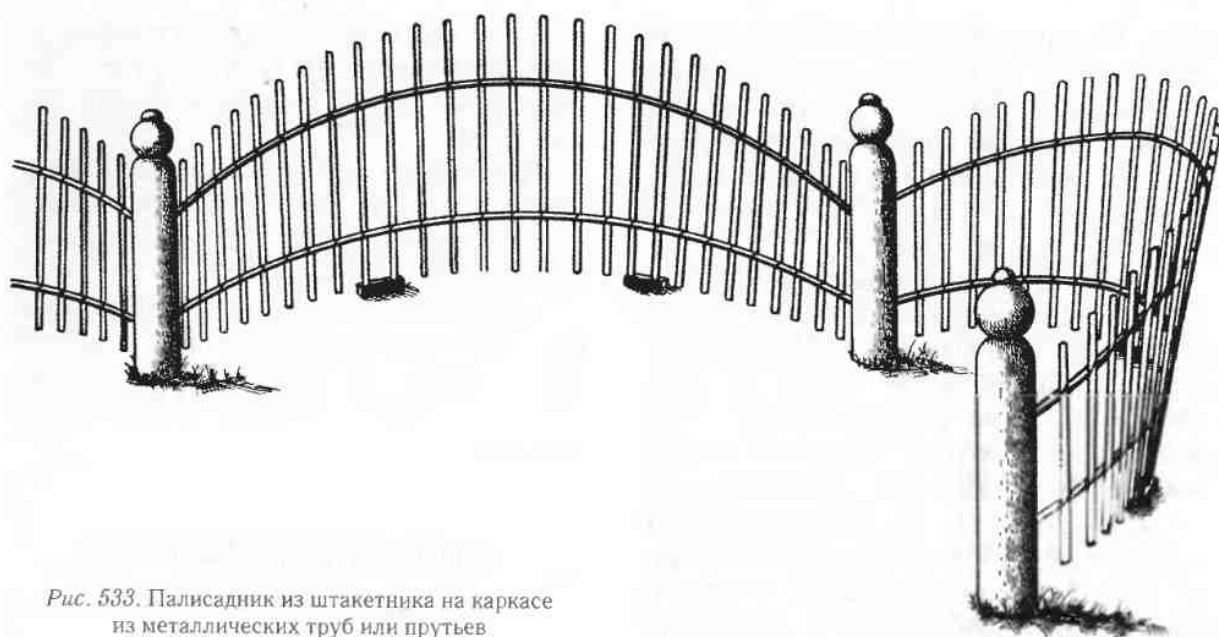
Палисадник из штакетника на каркасе из металлических труб или прутьев
